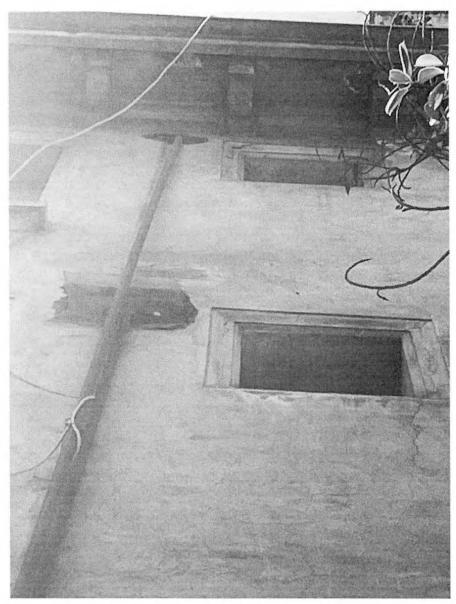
Fisuras en ventanas, daños en muros por pasada de servicios y desprendimientos en fachada norte, patio interior.
